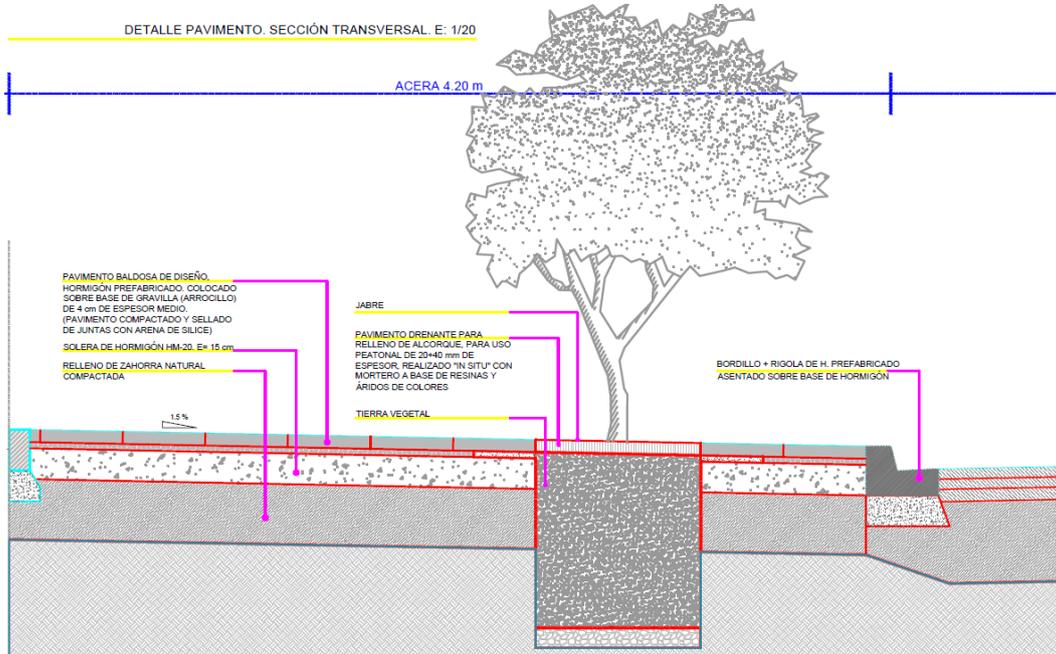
Detalle pavimento sección transversal. Lado Oeste
